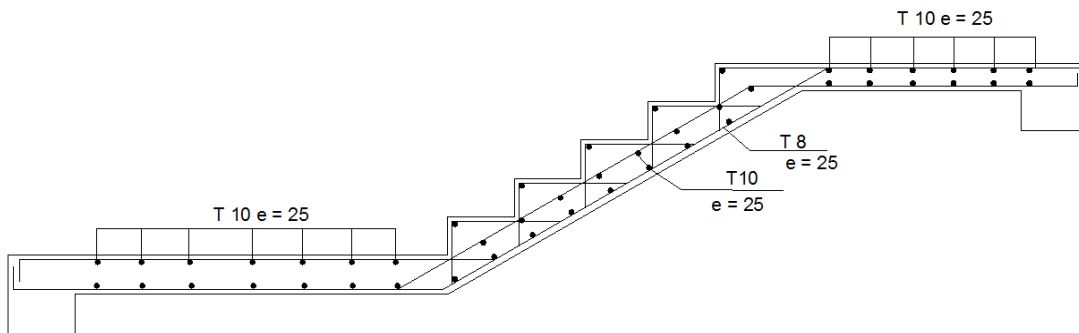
Ferrailage de l'Escalier (Volée II)
